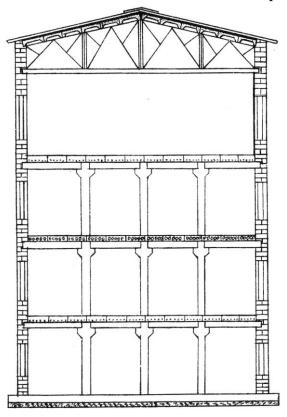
Поперечный разрез первого пожарного отсека проверяемого здания
